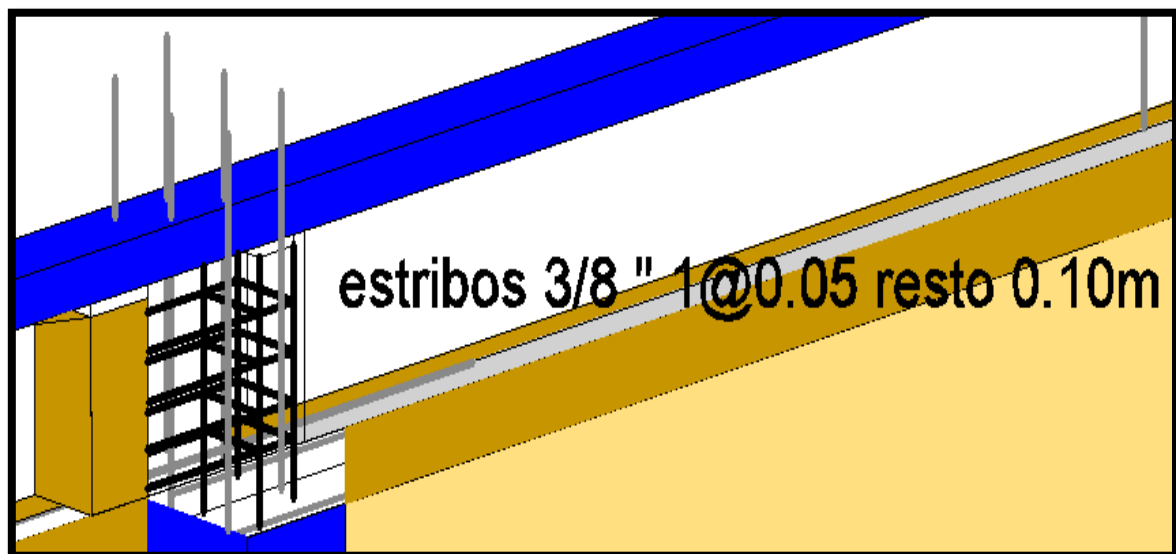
Distribución de los aceros en el ensanchamiento de la columna
